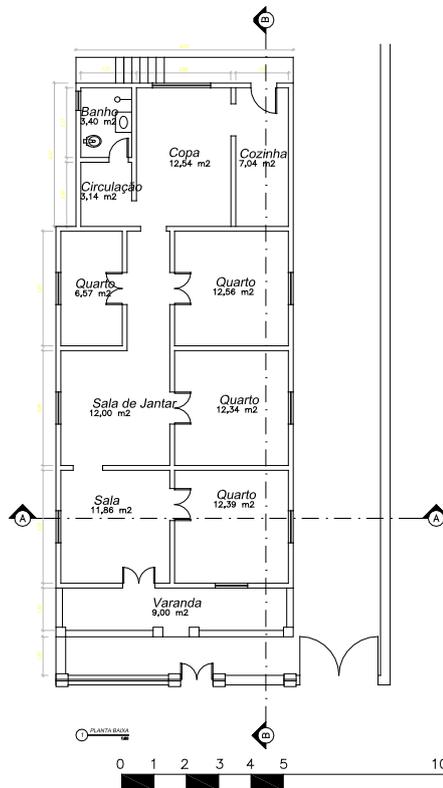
Planta Pavimento térreo - Casa Mariinha Fraga
